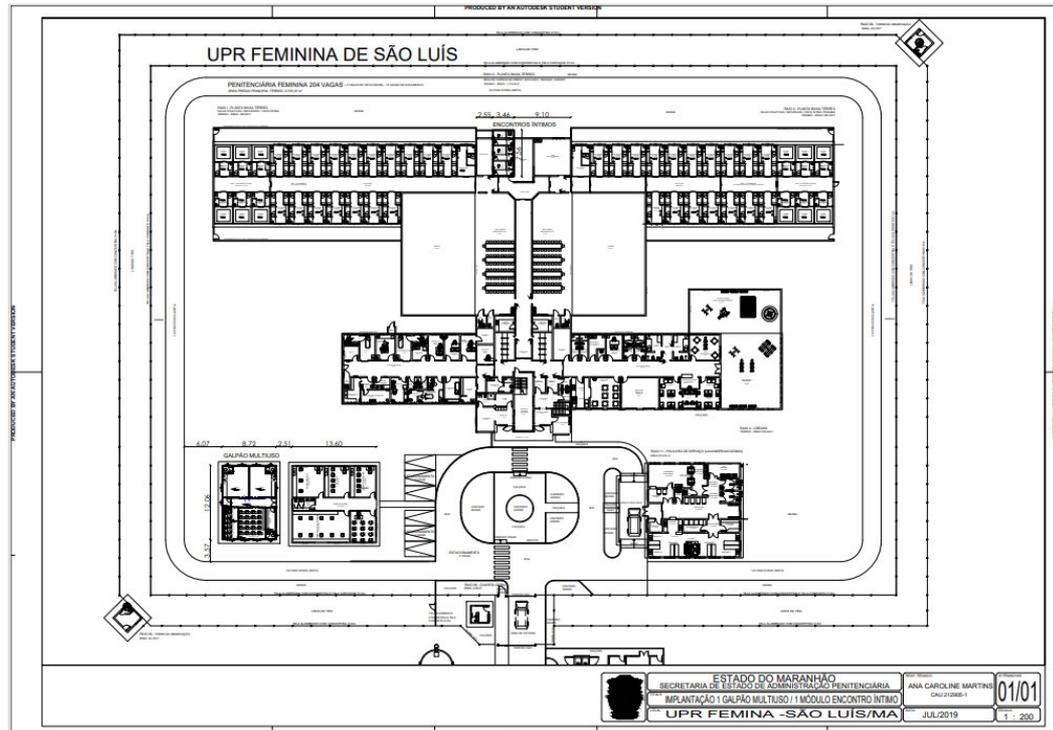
Planta baixa UPRF (BUNA, 2020)
